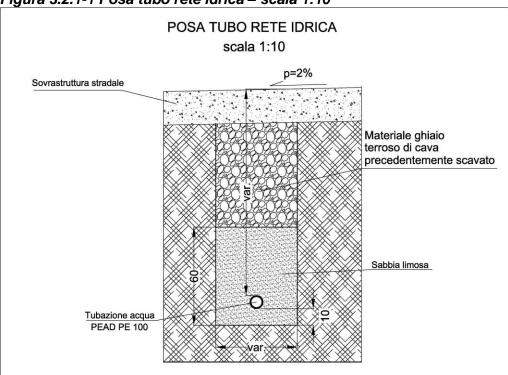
Posa tubo rete idrica – scala 1:10
